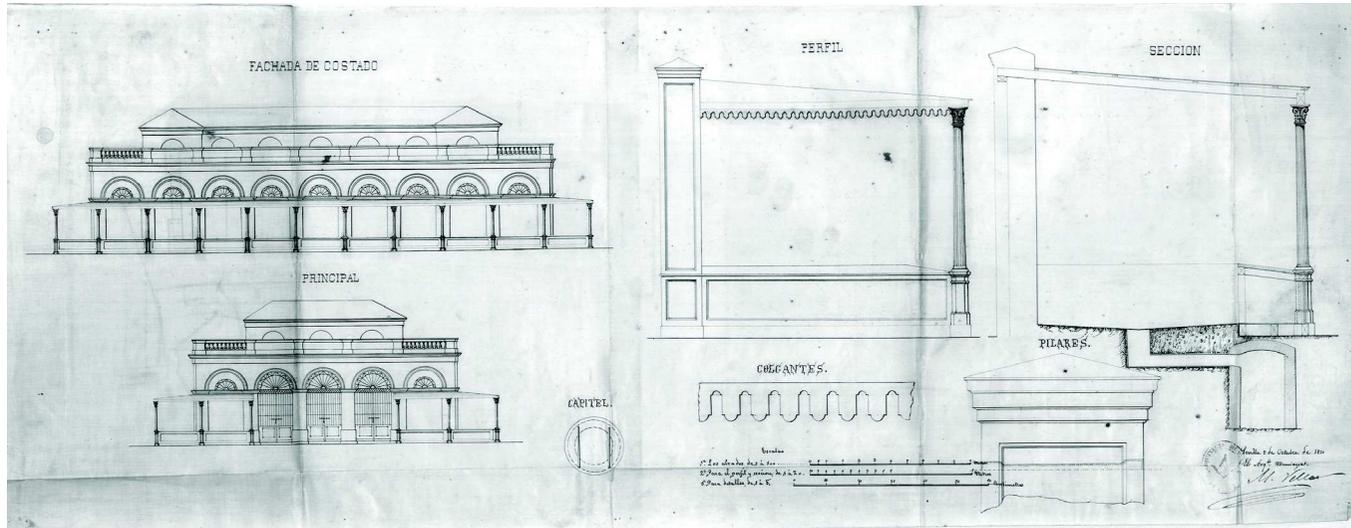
Plan de intervención en el pabellón de La Peninsular. M. Villar. 1870 (AHMS).
